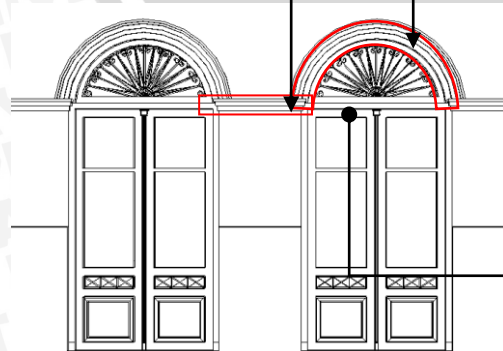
Ornamen pada dinding eksterior Stasiun Kereta Api Probolinggo
